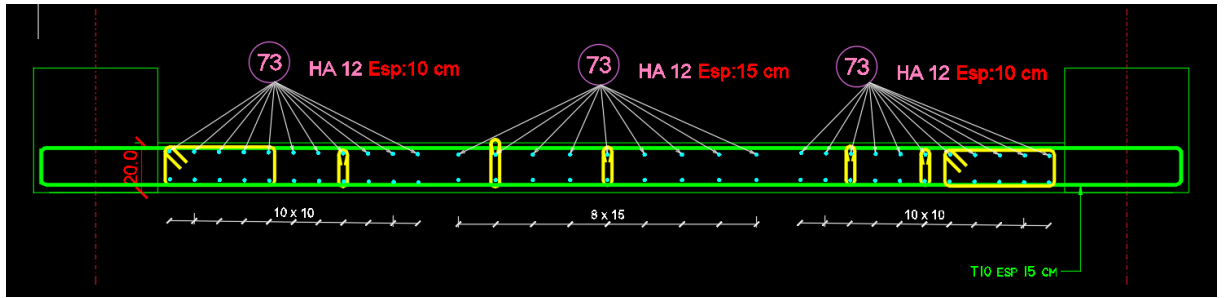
Exemple ferrailage voiles V1-V1'-V1'' de (5^{eme} -9^{eme} étage)
